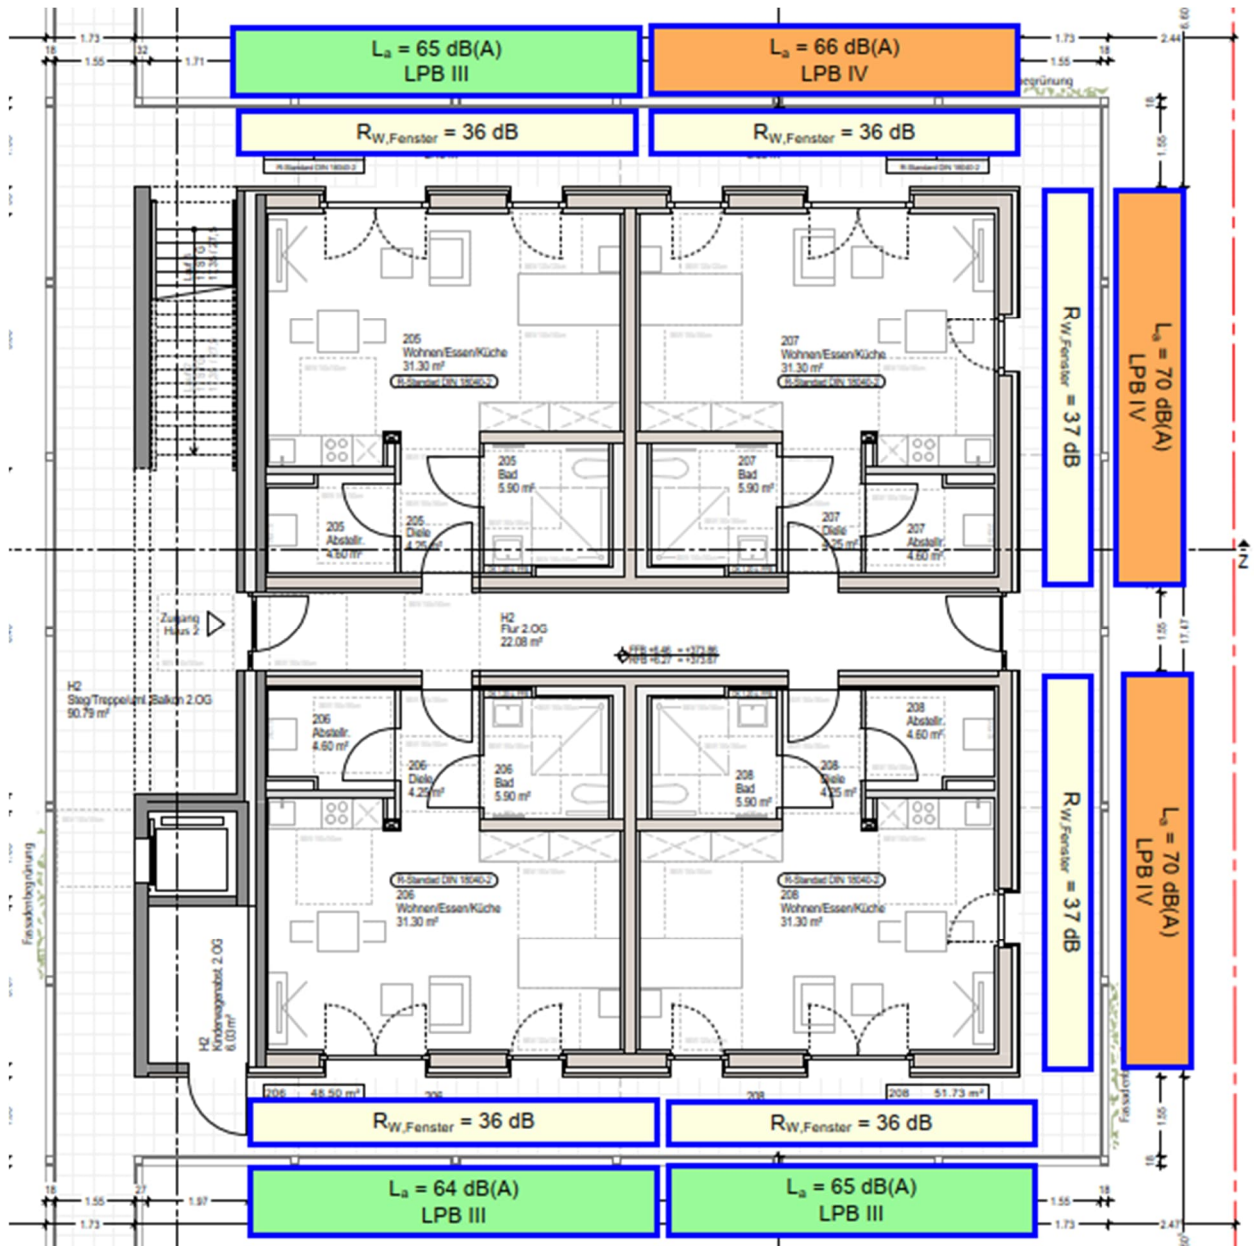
Außenlärm – Grundriss 2.OG – Haus 2
